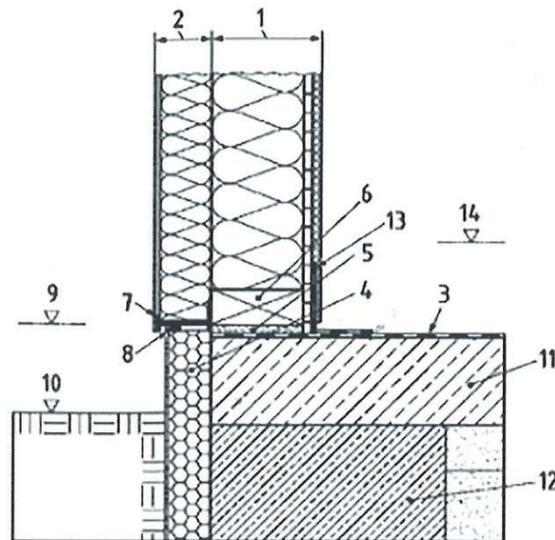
Parete esterna con soglia sporgente rispetto alla fondazione con sistema di isolamento termico
